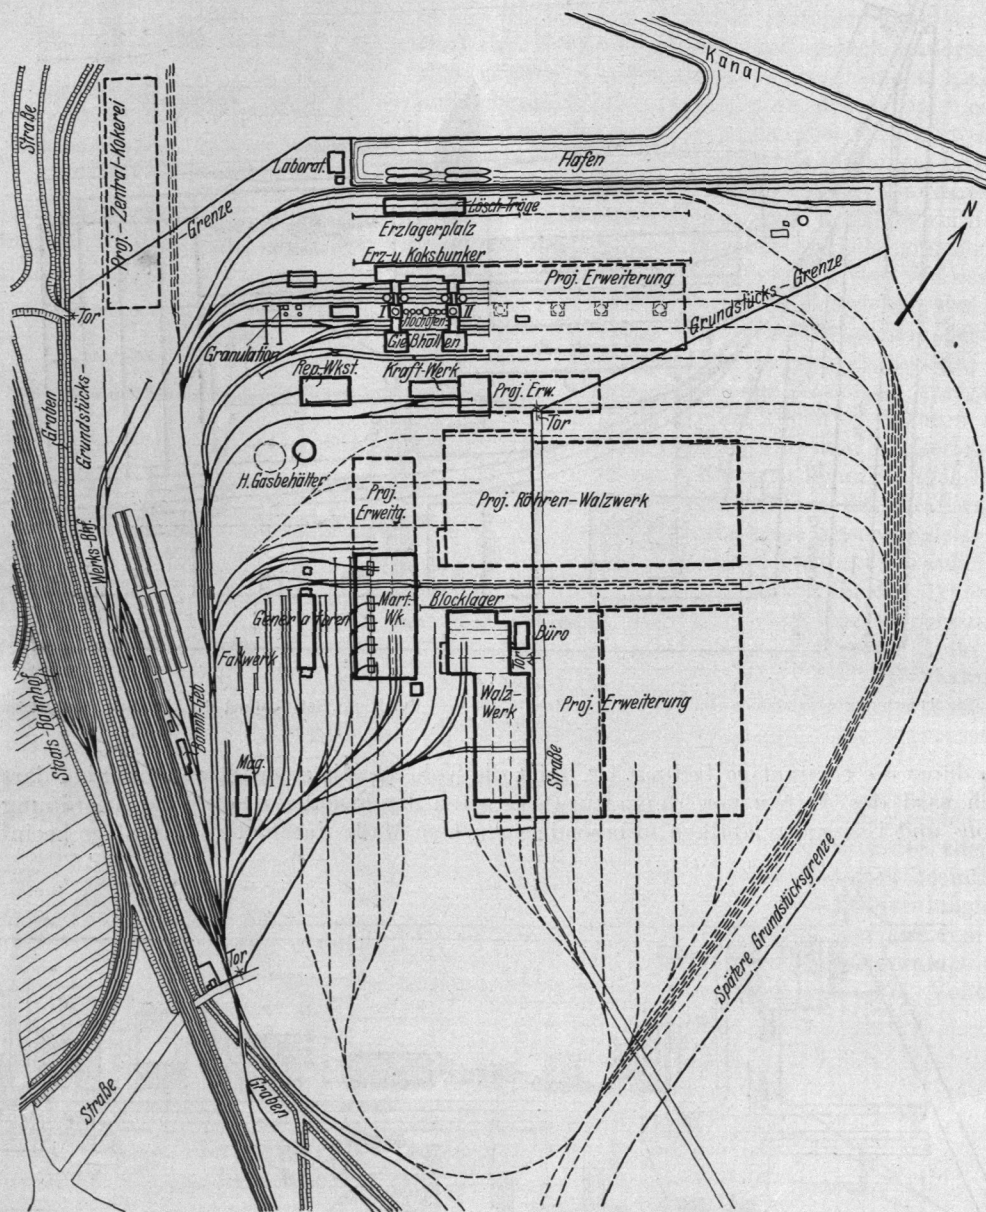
Lageplan eines Werkes der Schwerindustrie.
